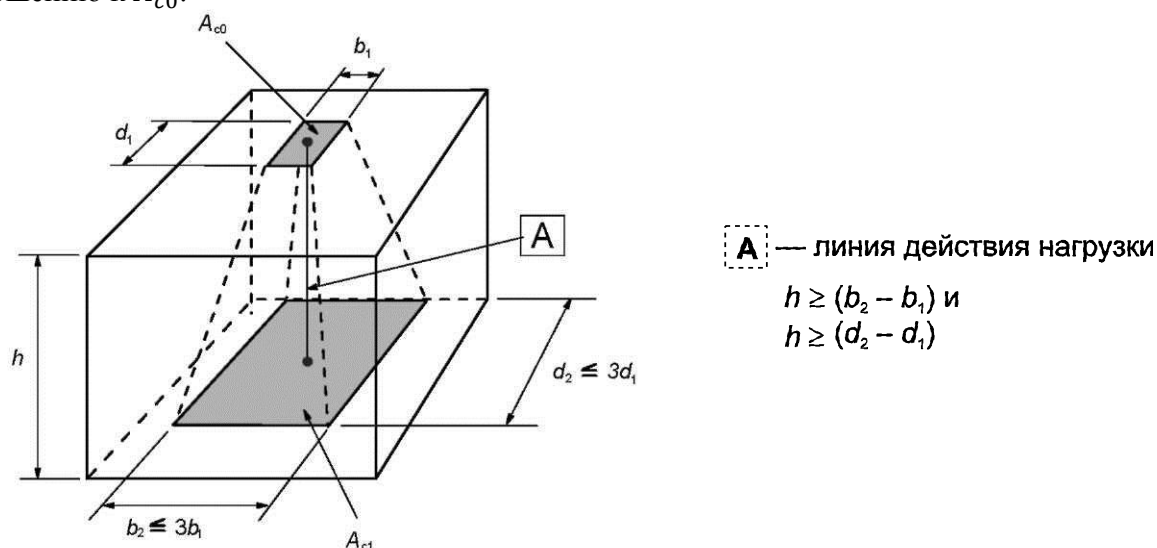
Расчетная схема для частично нагруженных площадок
